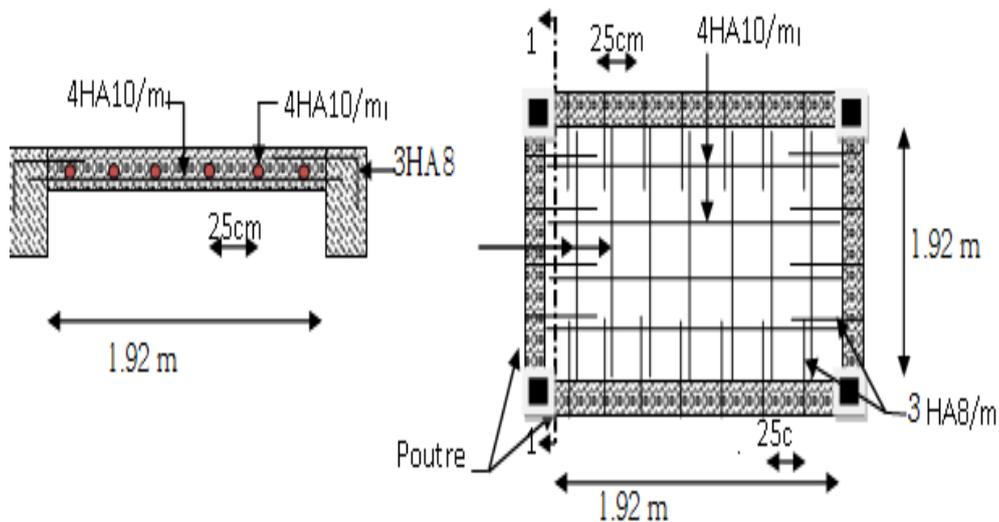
Schéma de ferrailage dalle pleine du locale machinerie
